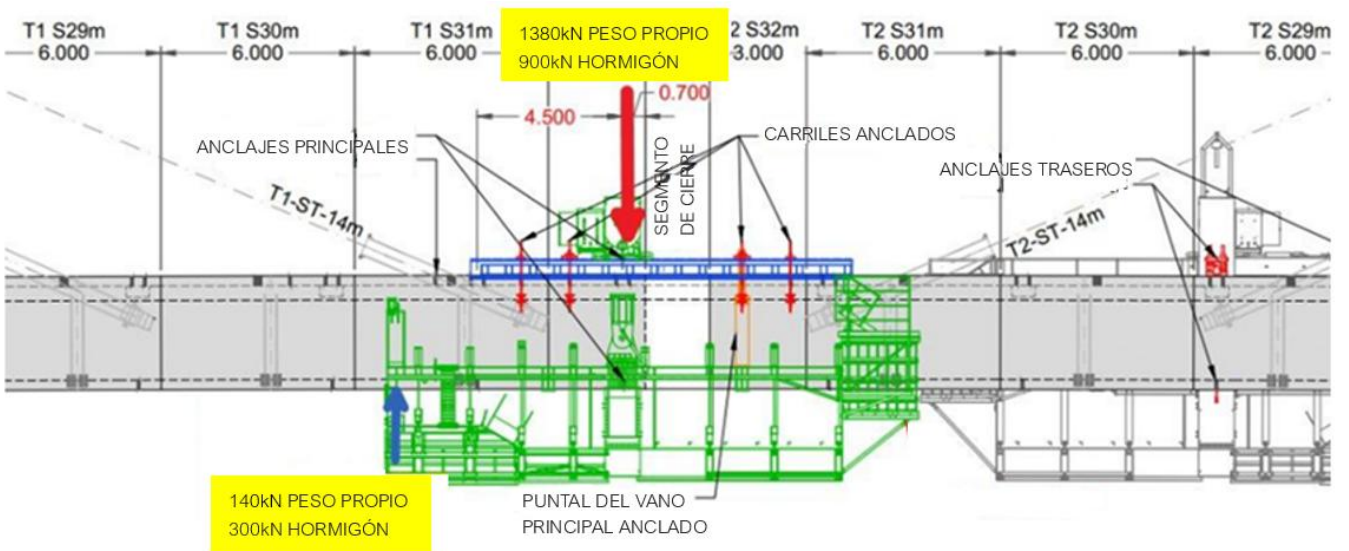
Encofrado interior listo para el lanzamiento final del segmento de cierre
